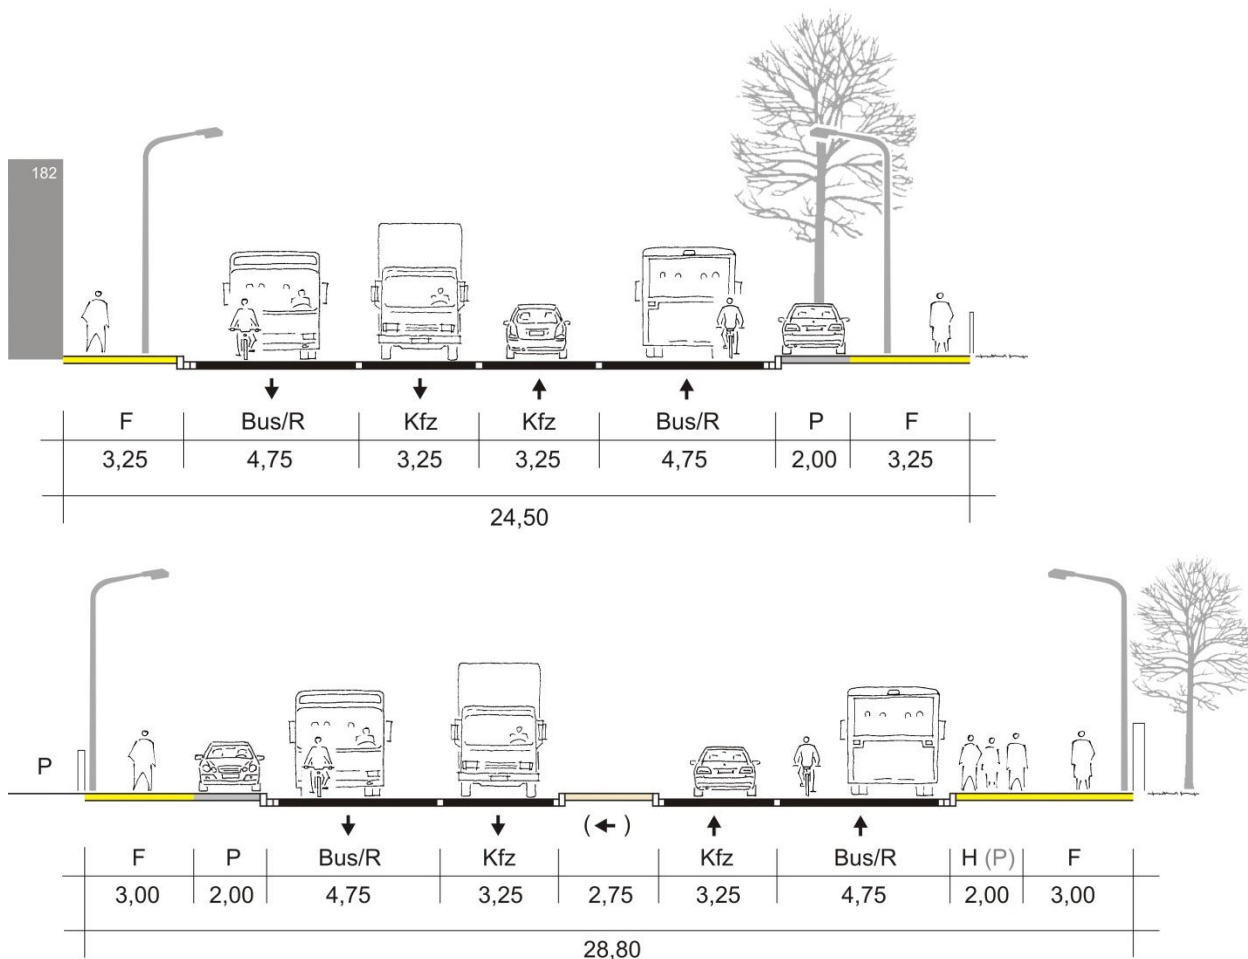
Gestaltungsvorschlag Mindener Straße – Variante 2 für die Straßenraumquerschnitte A-A (oben) und B-B (unten)
